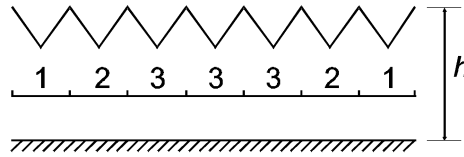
Freistehende Sheddächer mit Dachflächenbezeichnung
